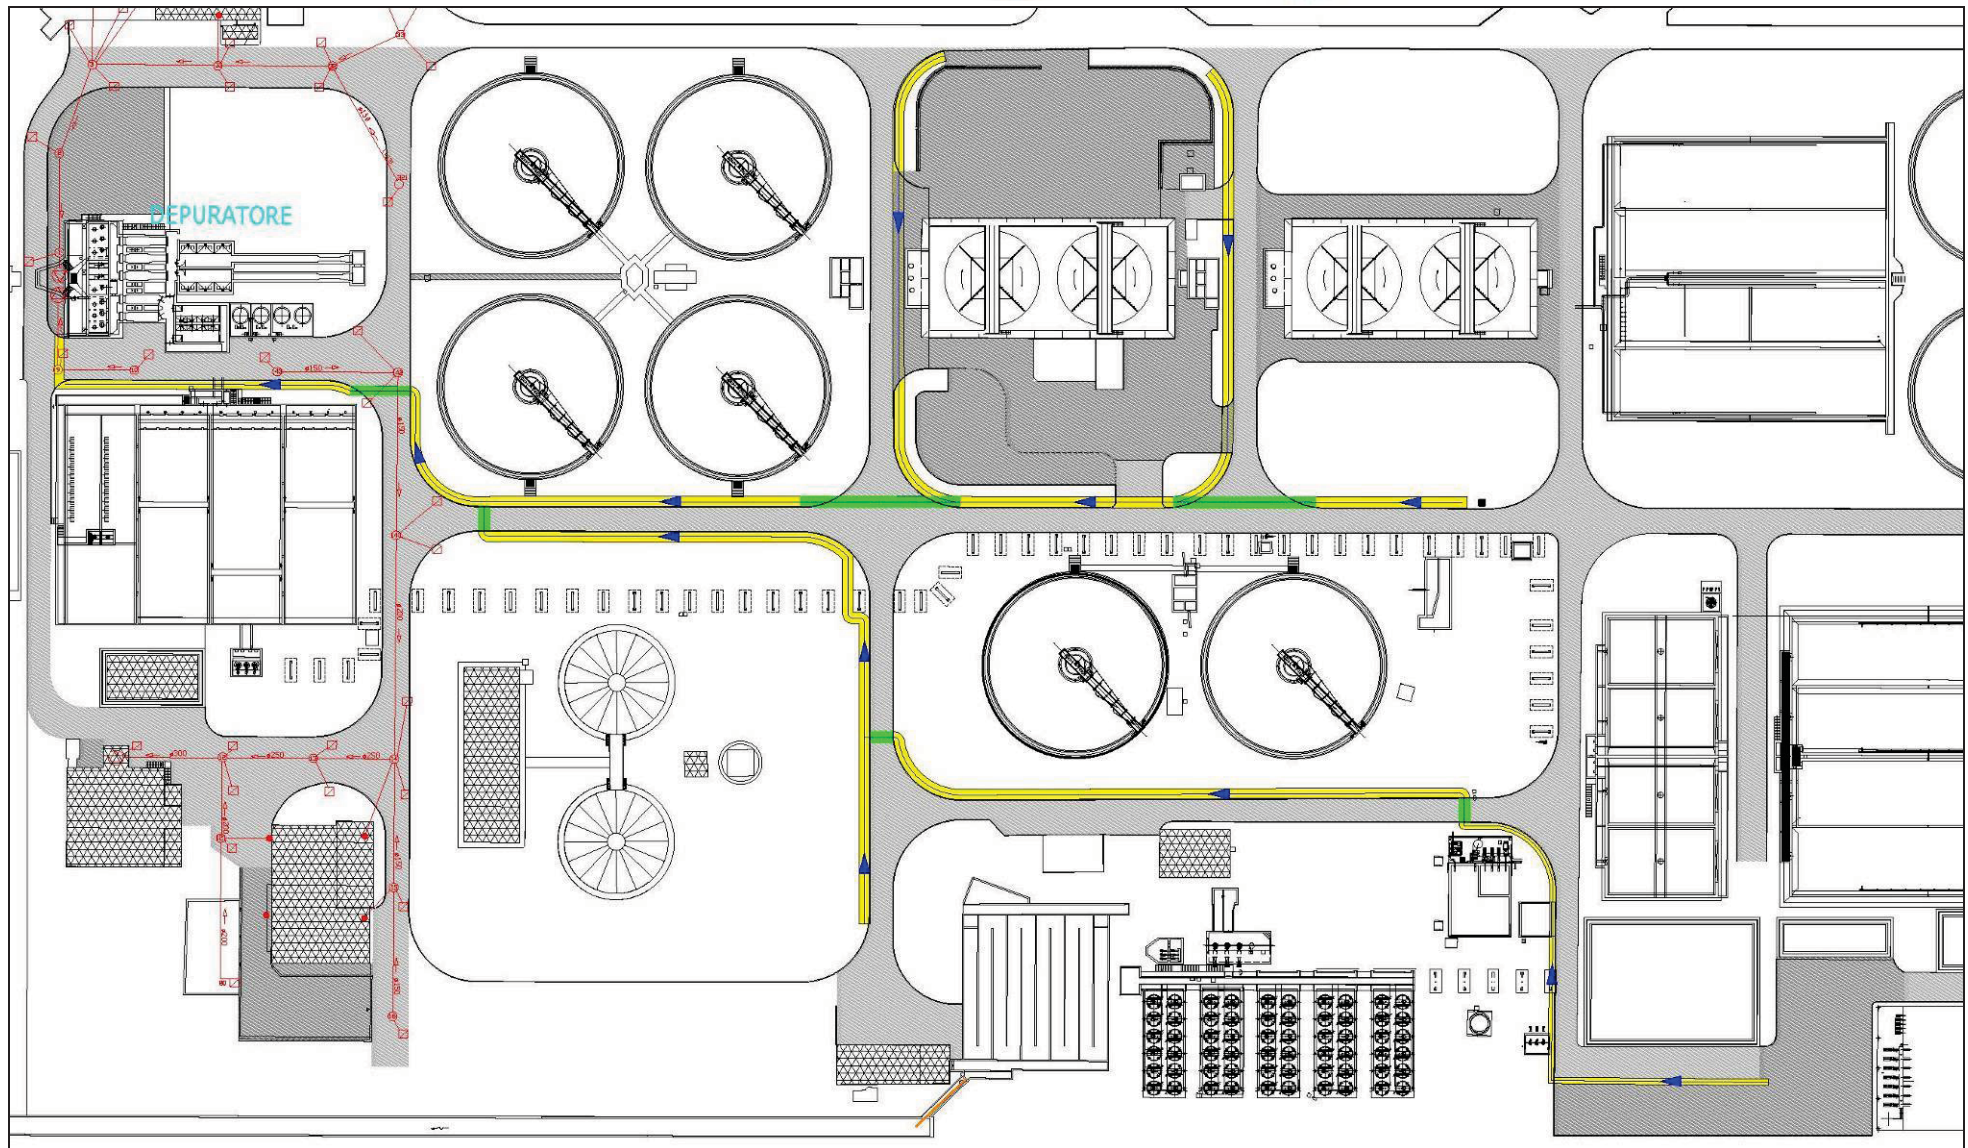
Stralcio della tavola di progetto n.3 che rappresenta lo schema delle cunette in progetto
